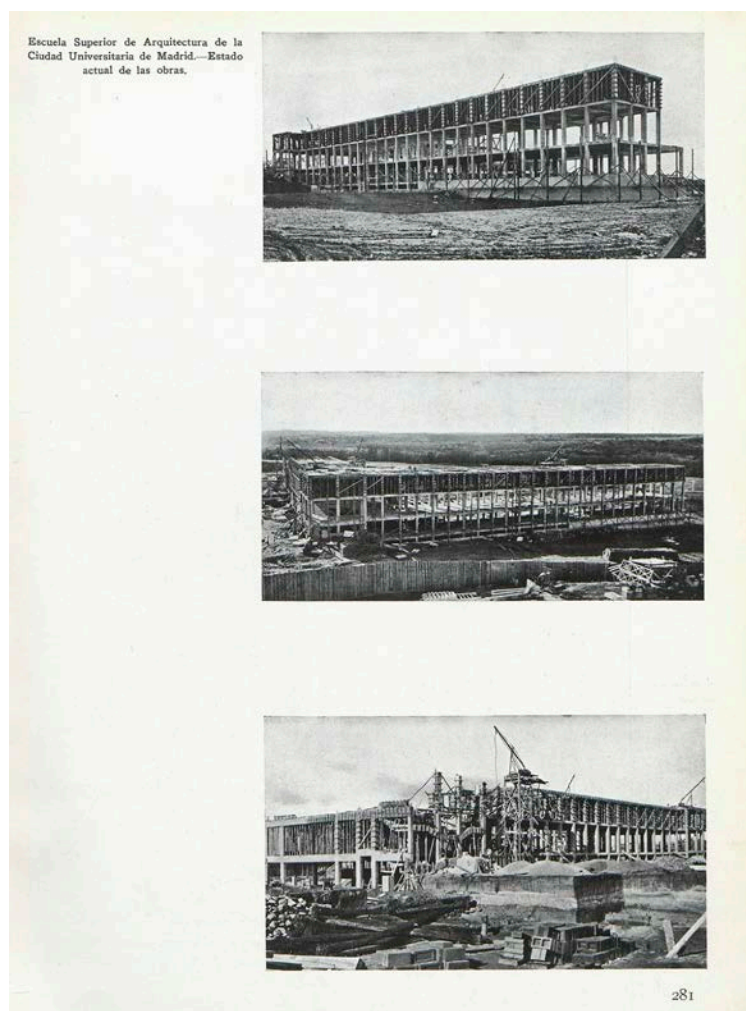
Imágenes de la Facultad de Arquitectura en construcción, publicadas en la revista *Arquitectura*, 1933.
